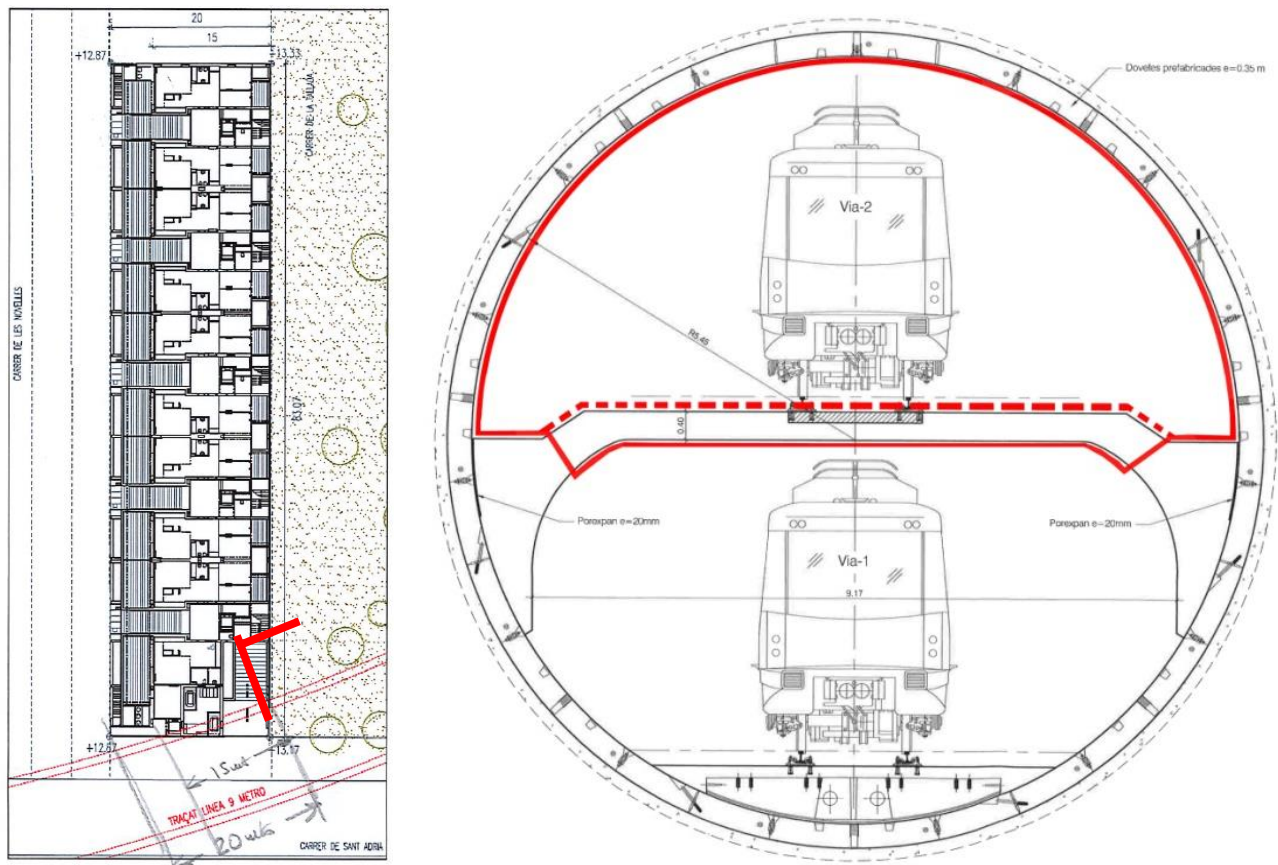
Planta de detalle del edificio con relación al túnel del metro y sección del trazado de la fibra óptica.
